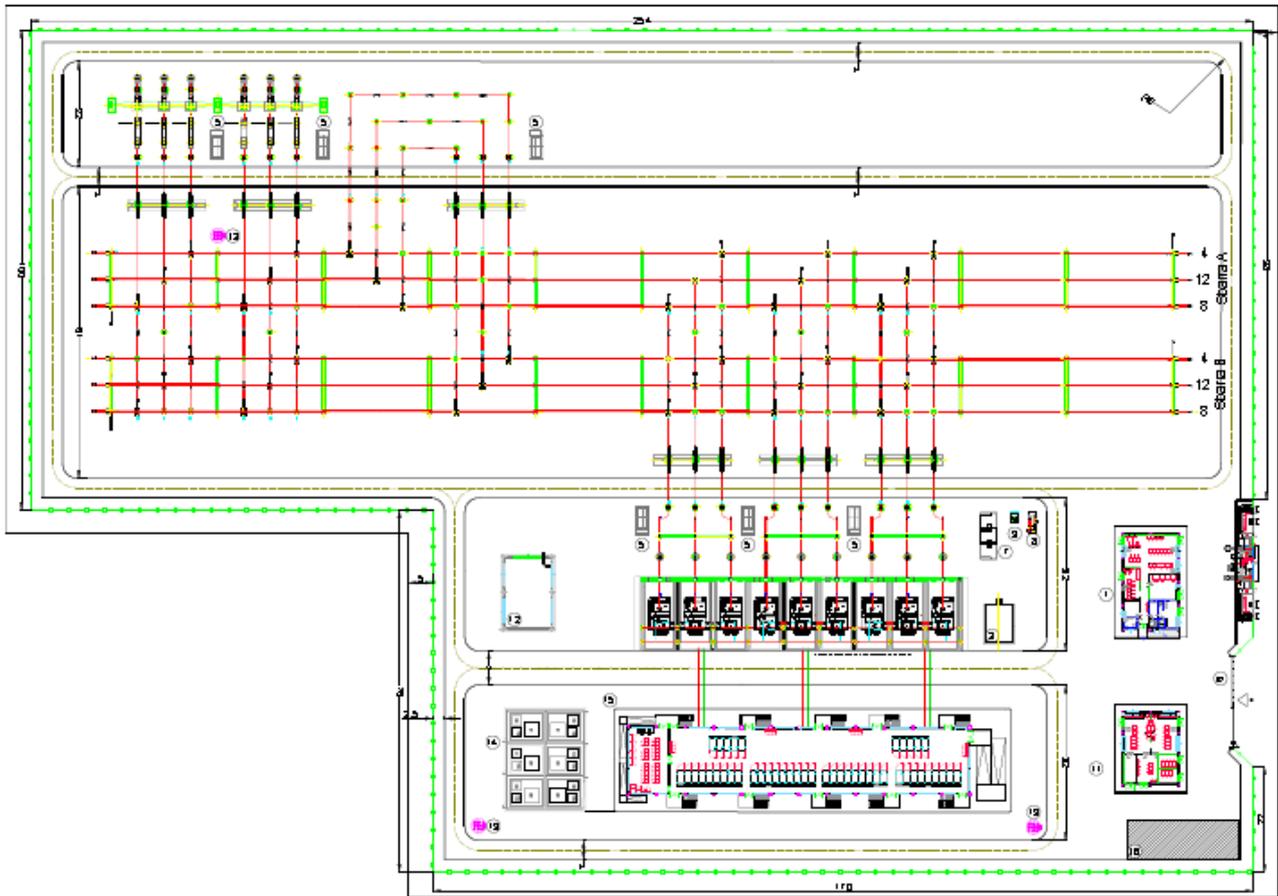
PLANIMETRIA ELETTROMECCANICA GENERALE
